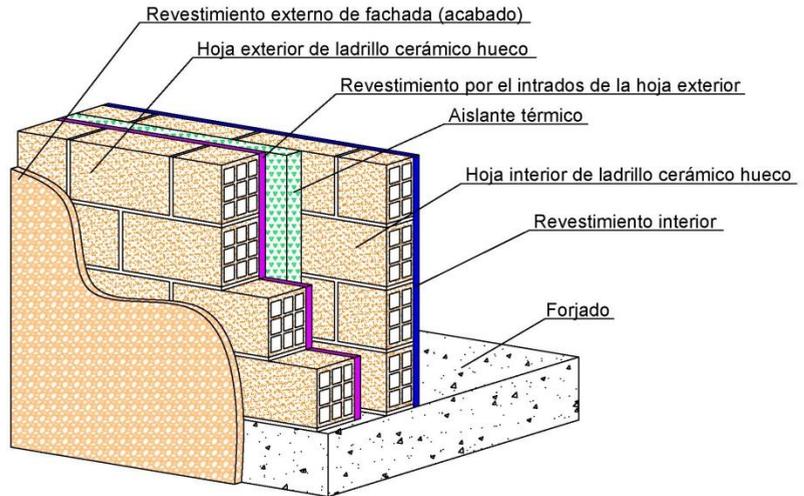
Detalle de fachada para revestir. Fuente propia
